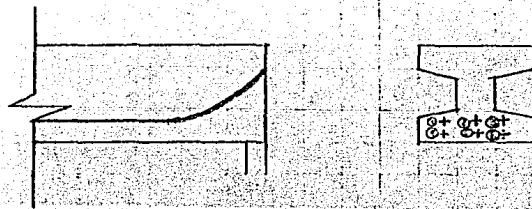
Pérdidas por descarrilamiento del Concreto en elementos postensados.
